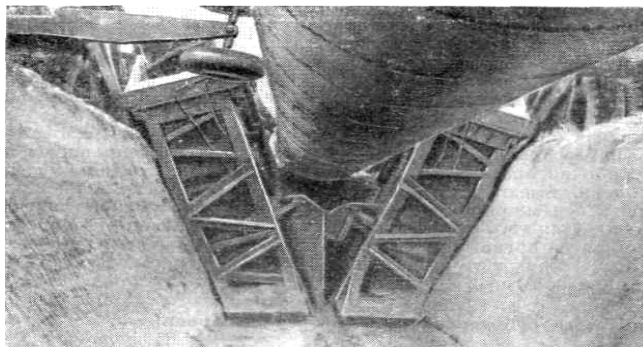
Разработка траншеи под трубопроводом двухсторонним экскаватором-трубозаглубителем продольного копания
